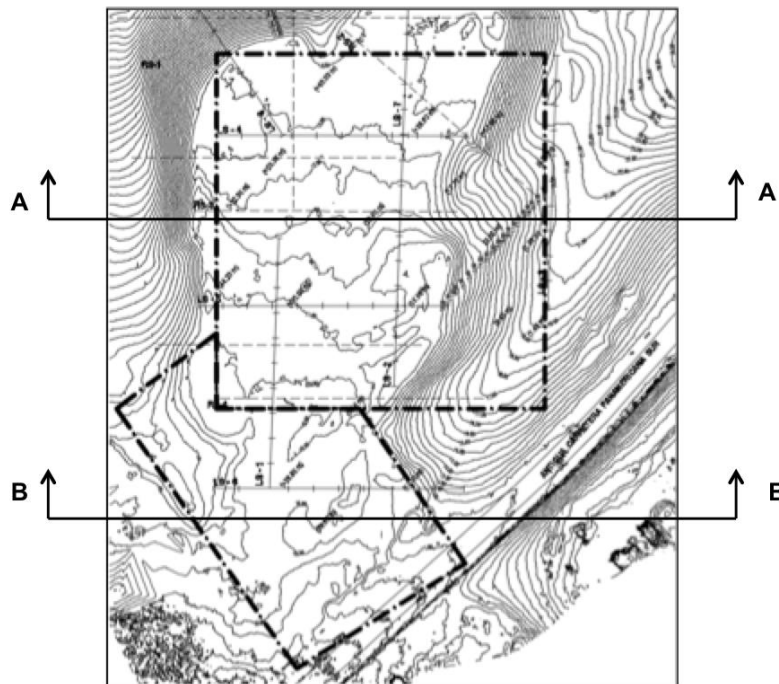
Vista em Planta da topografia do terreno (Vela, P., 2014).
